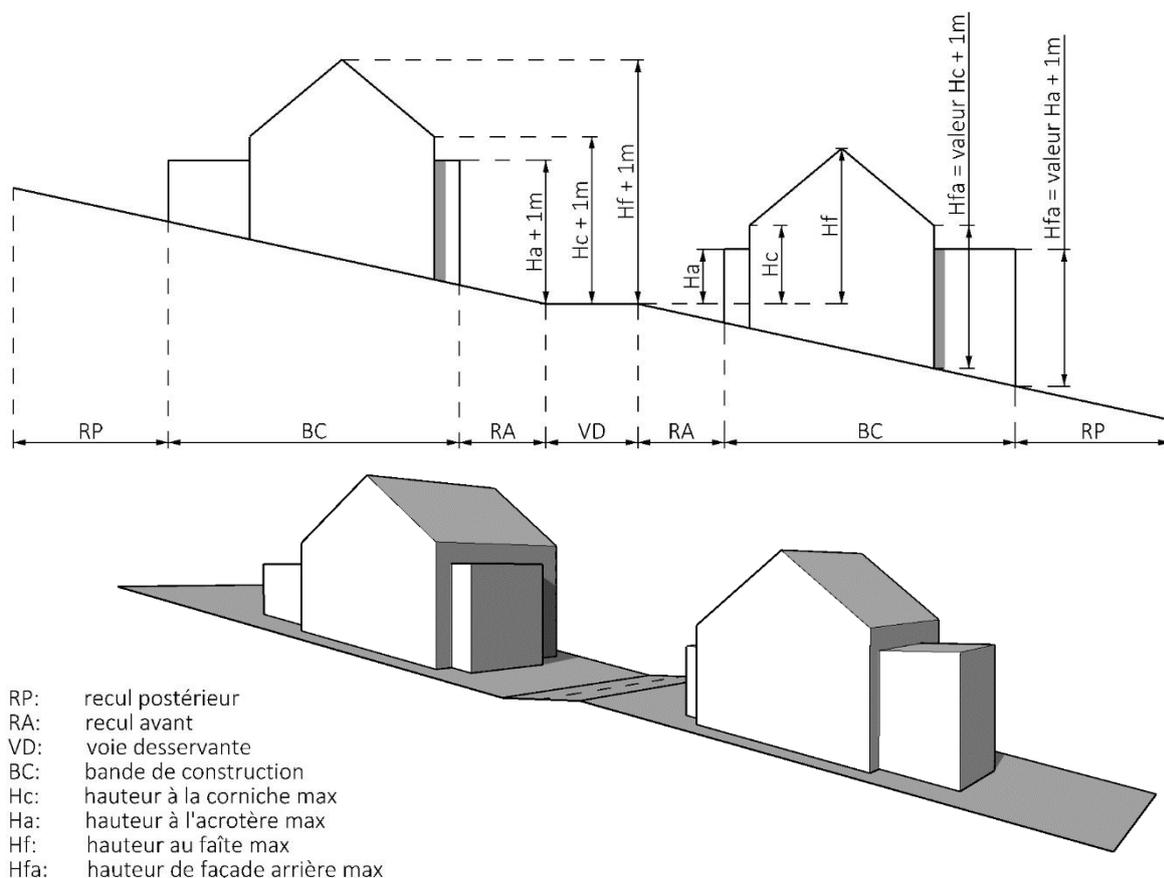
Hauteur des immeubles sur « terrain à forte pente »
